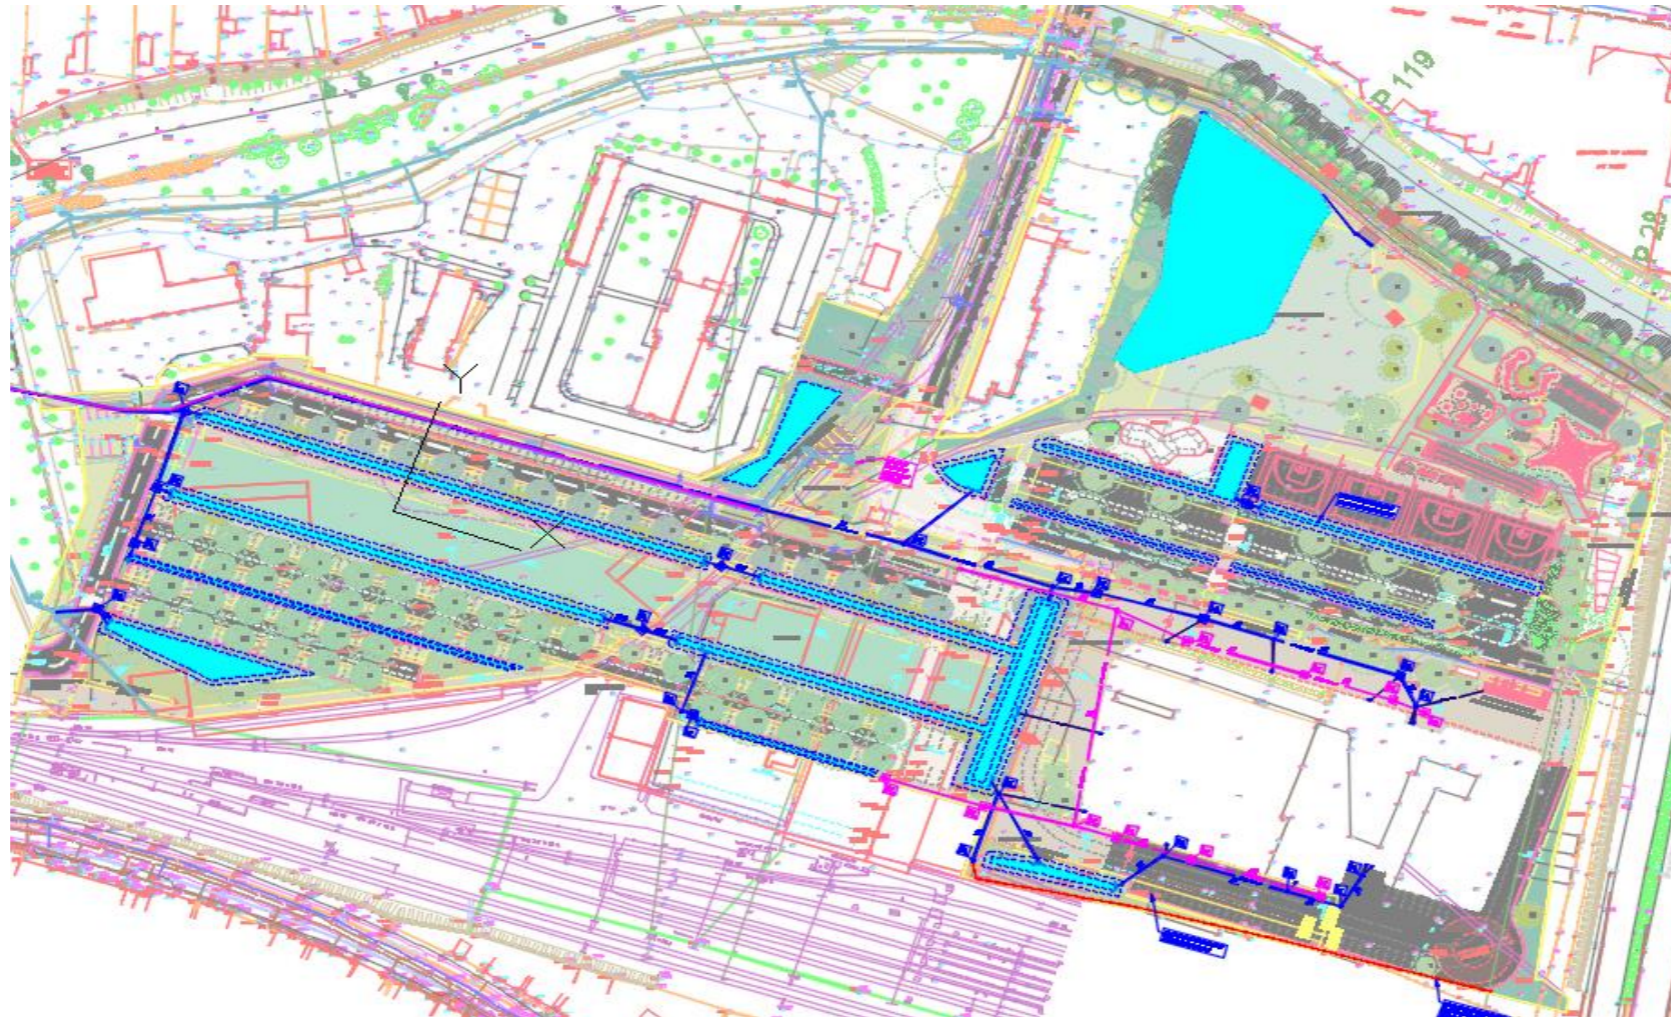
extrait du plan assainissement, avec fond de noues et de bassins en cyan
